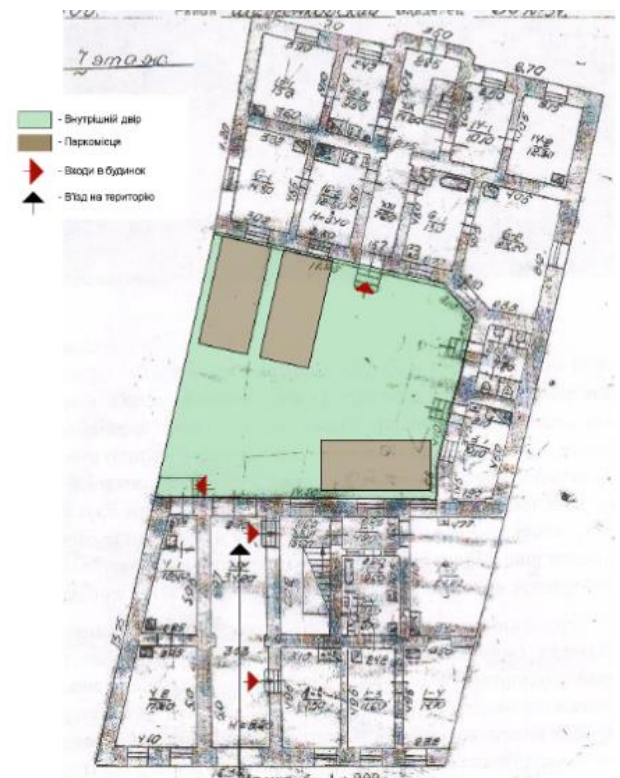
Приклад аналізу благоустрою двору житлового будинку
